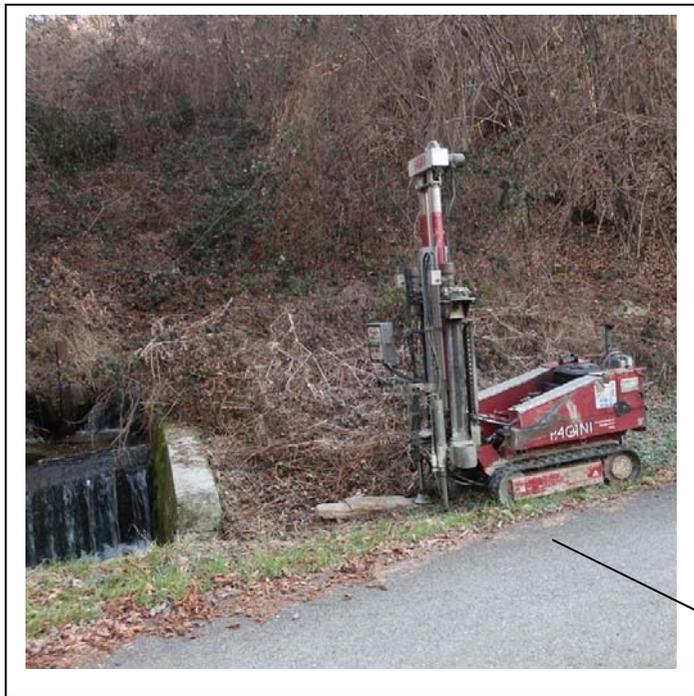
Lato attraversamento valle strada con attrezzatura prova penetrometrica Din2
